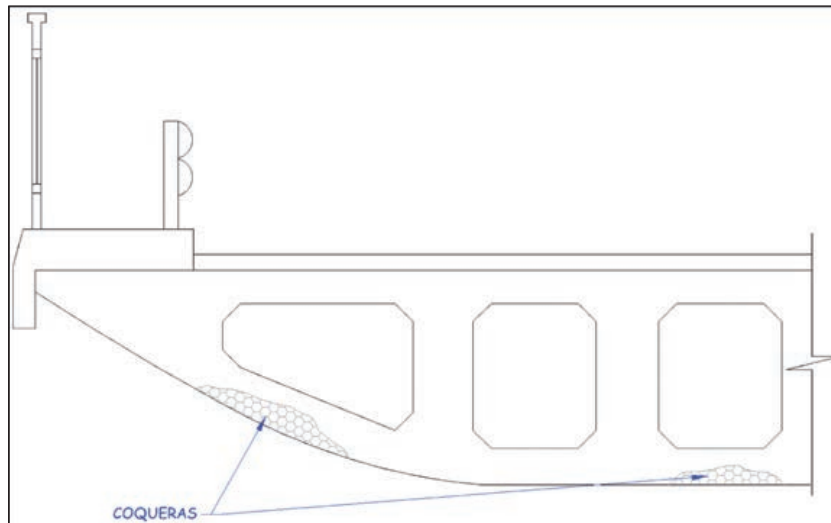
ZONAS PROPENSAS A LA EXISTENCIA DE COQUERAS EN UNA LOSA ALIGERADA DE HORMIGÓN.
